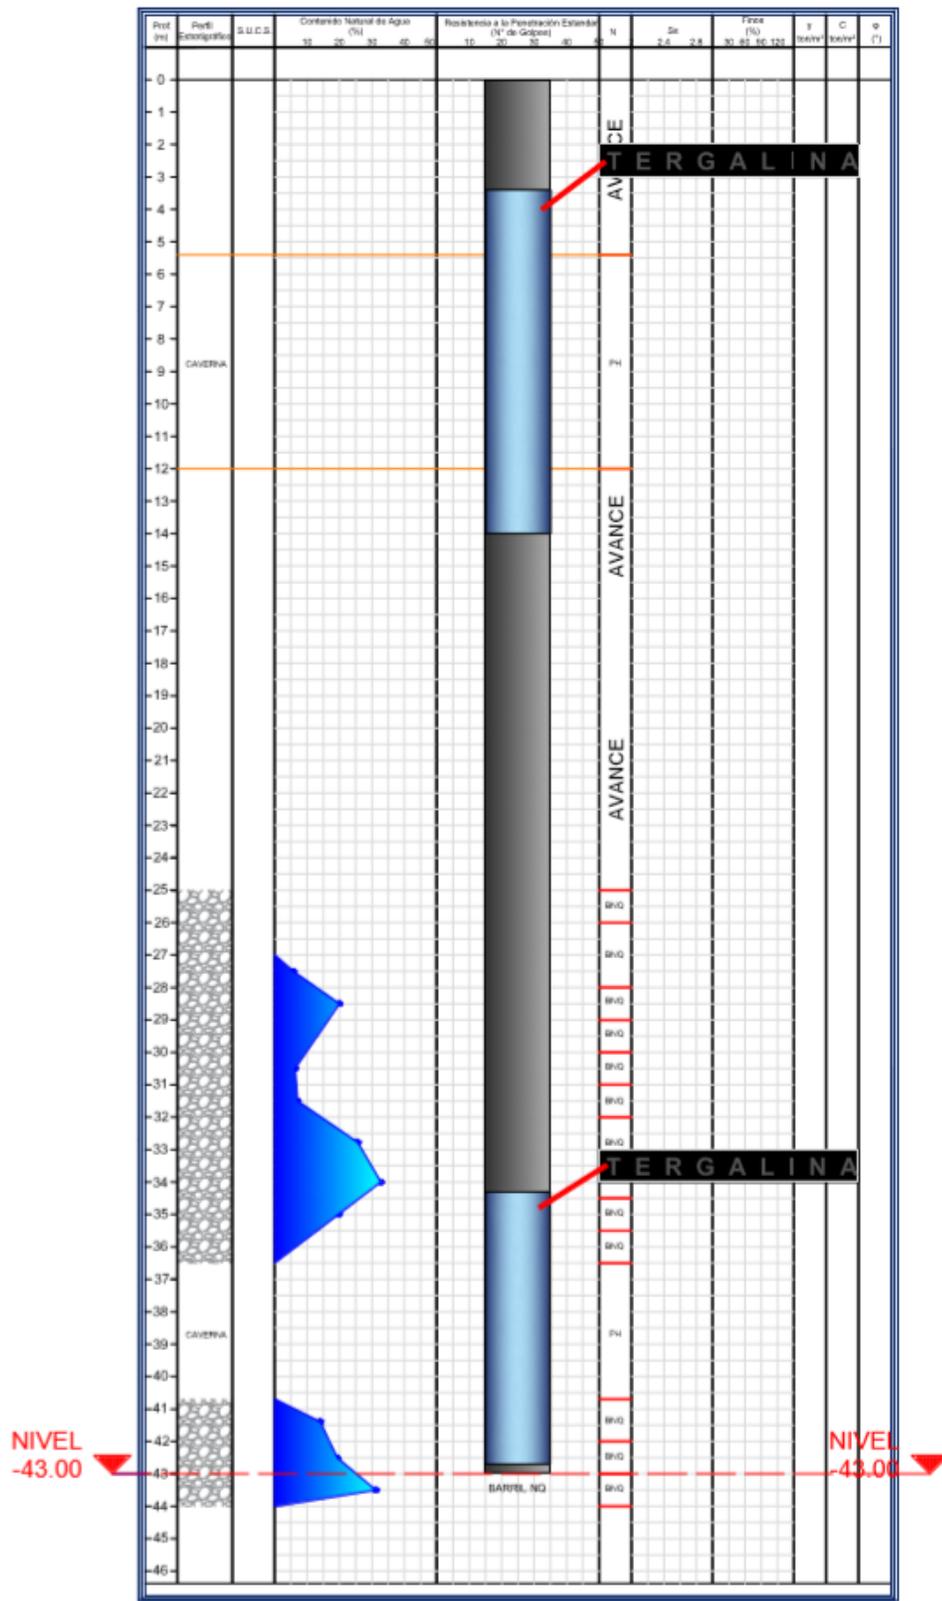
DESPLANTE DE PILA 25 (SM-17-EJE I3).
